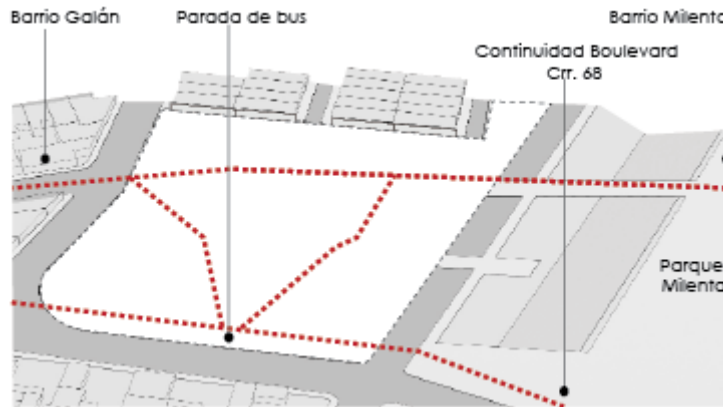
Conexiones en planta baja. (Torres, C. 2022)
